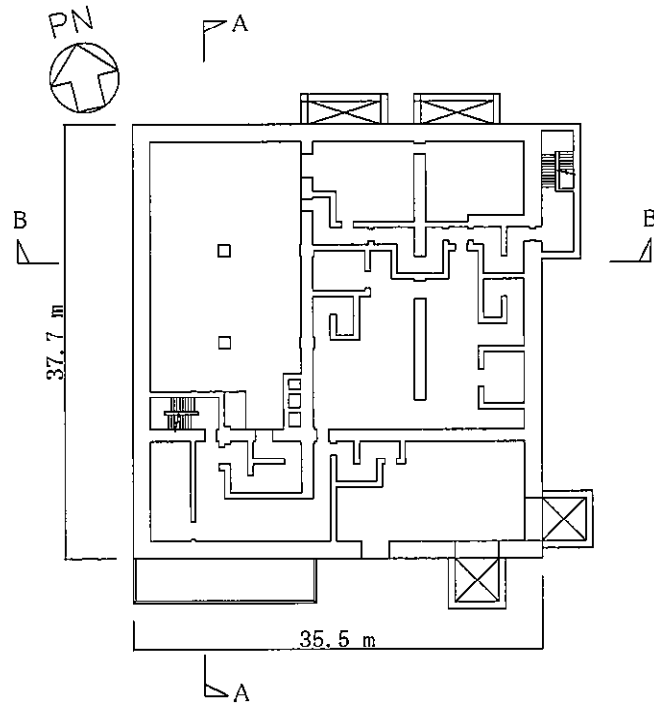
緊急時対策所建屋の概略平面図 (EL. 30.3 m)
